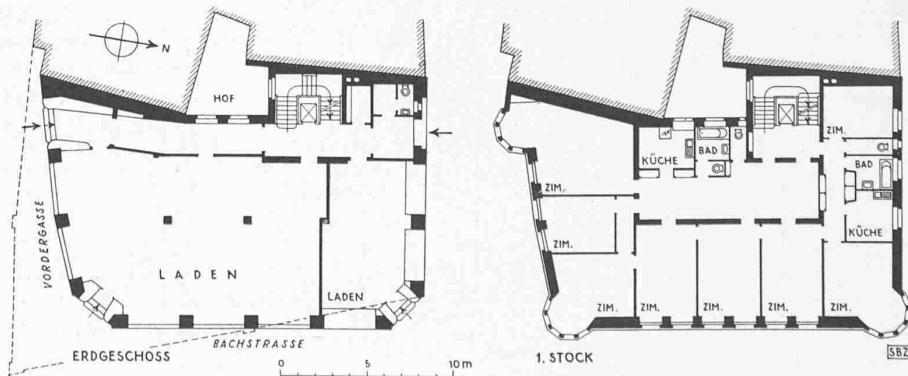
Neubau «Zur Platte» in Schaffhausen. Grundrisse 1 : 400
